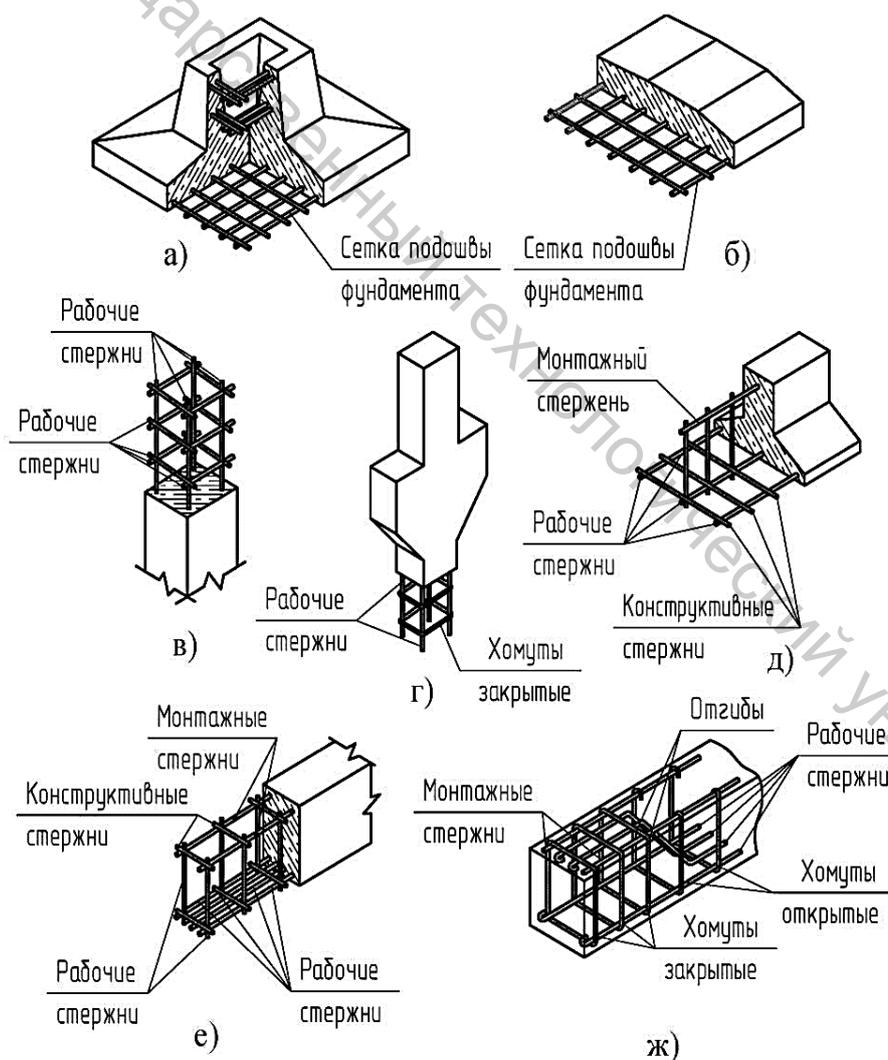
Типовые железобетонные изделия и их армирование:
